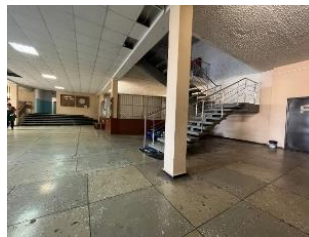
Металлическая лестница подъема на перекрытие +3.715 с холла первого этажа
